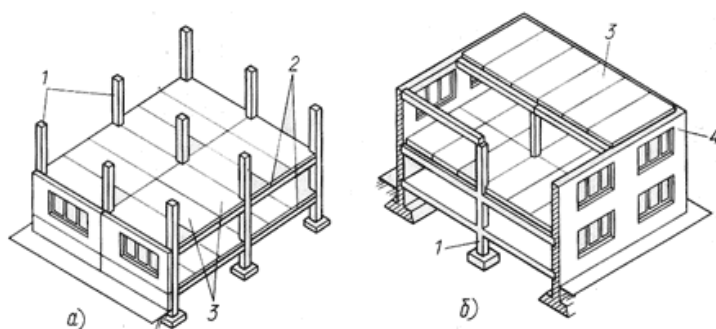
Конструктивные схемы зданий: а — с полным каркасом, б — с неполным каркасом; 1 — колонны, 2 — ригели, 3 — панели перекрытий, 4 — несущие наружные стены
